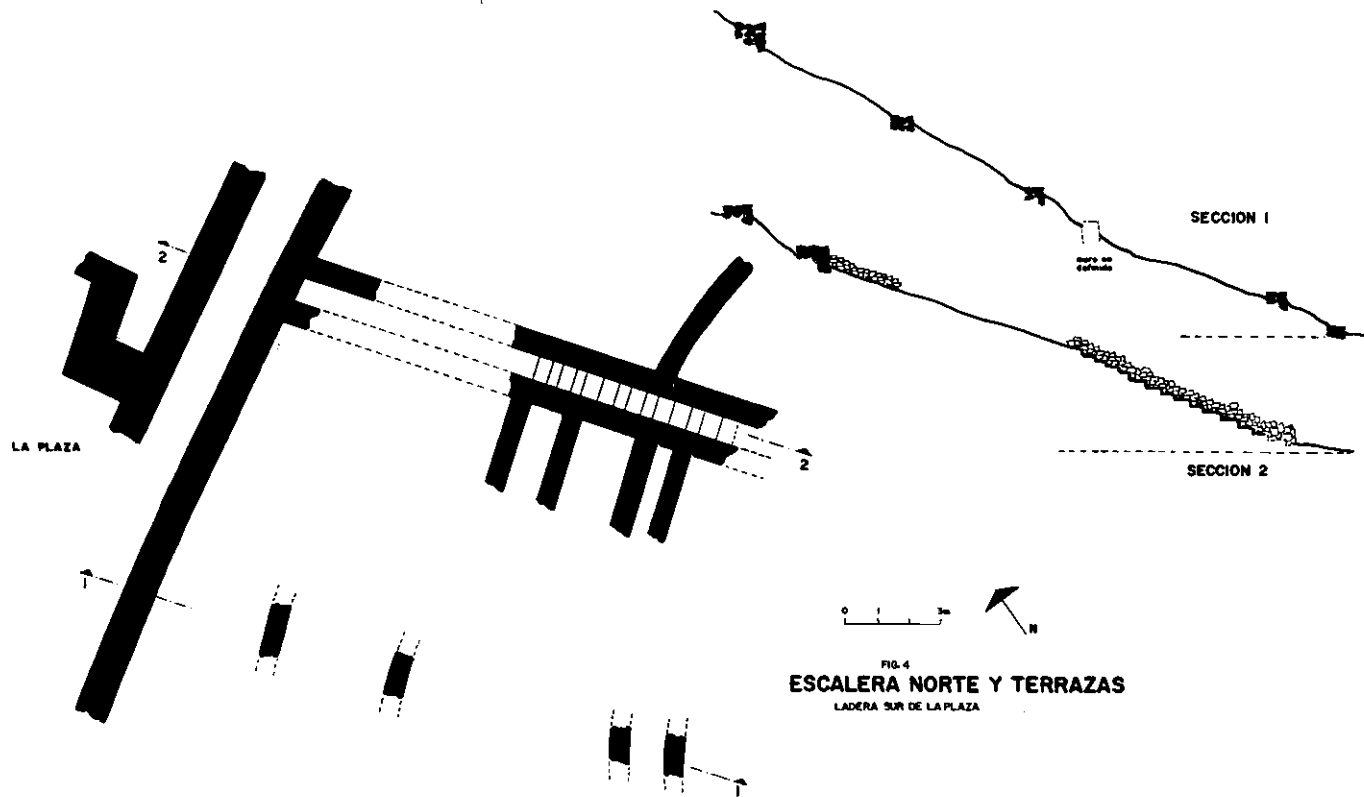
Escala norte y terrazas. Ladera sur de la plaza.
